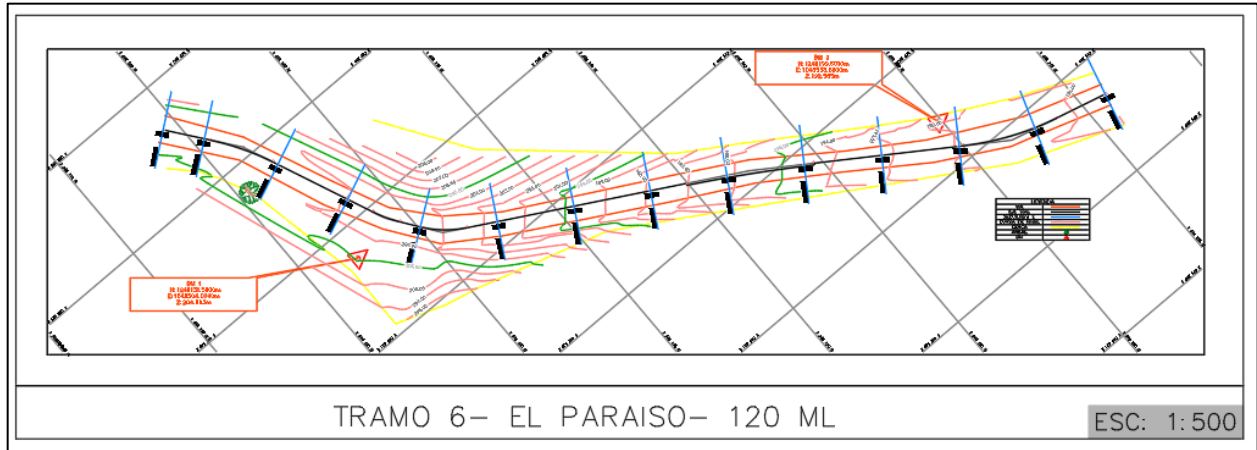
Imagen de planta del tramo 6 del proyecto de San Vicente de Chucuri-Santander
